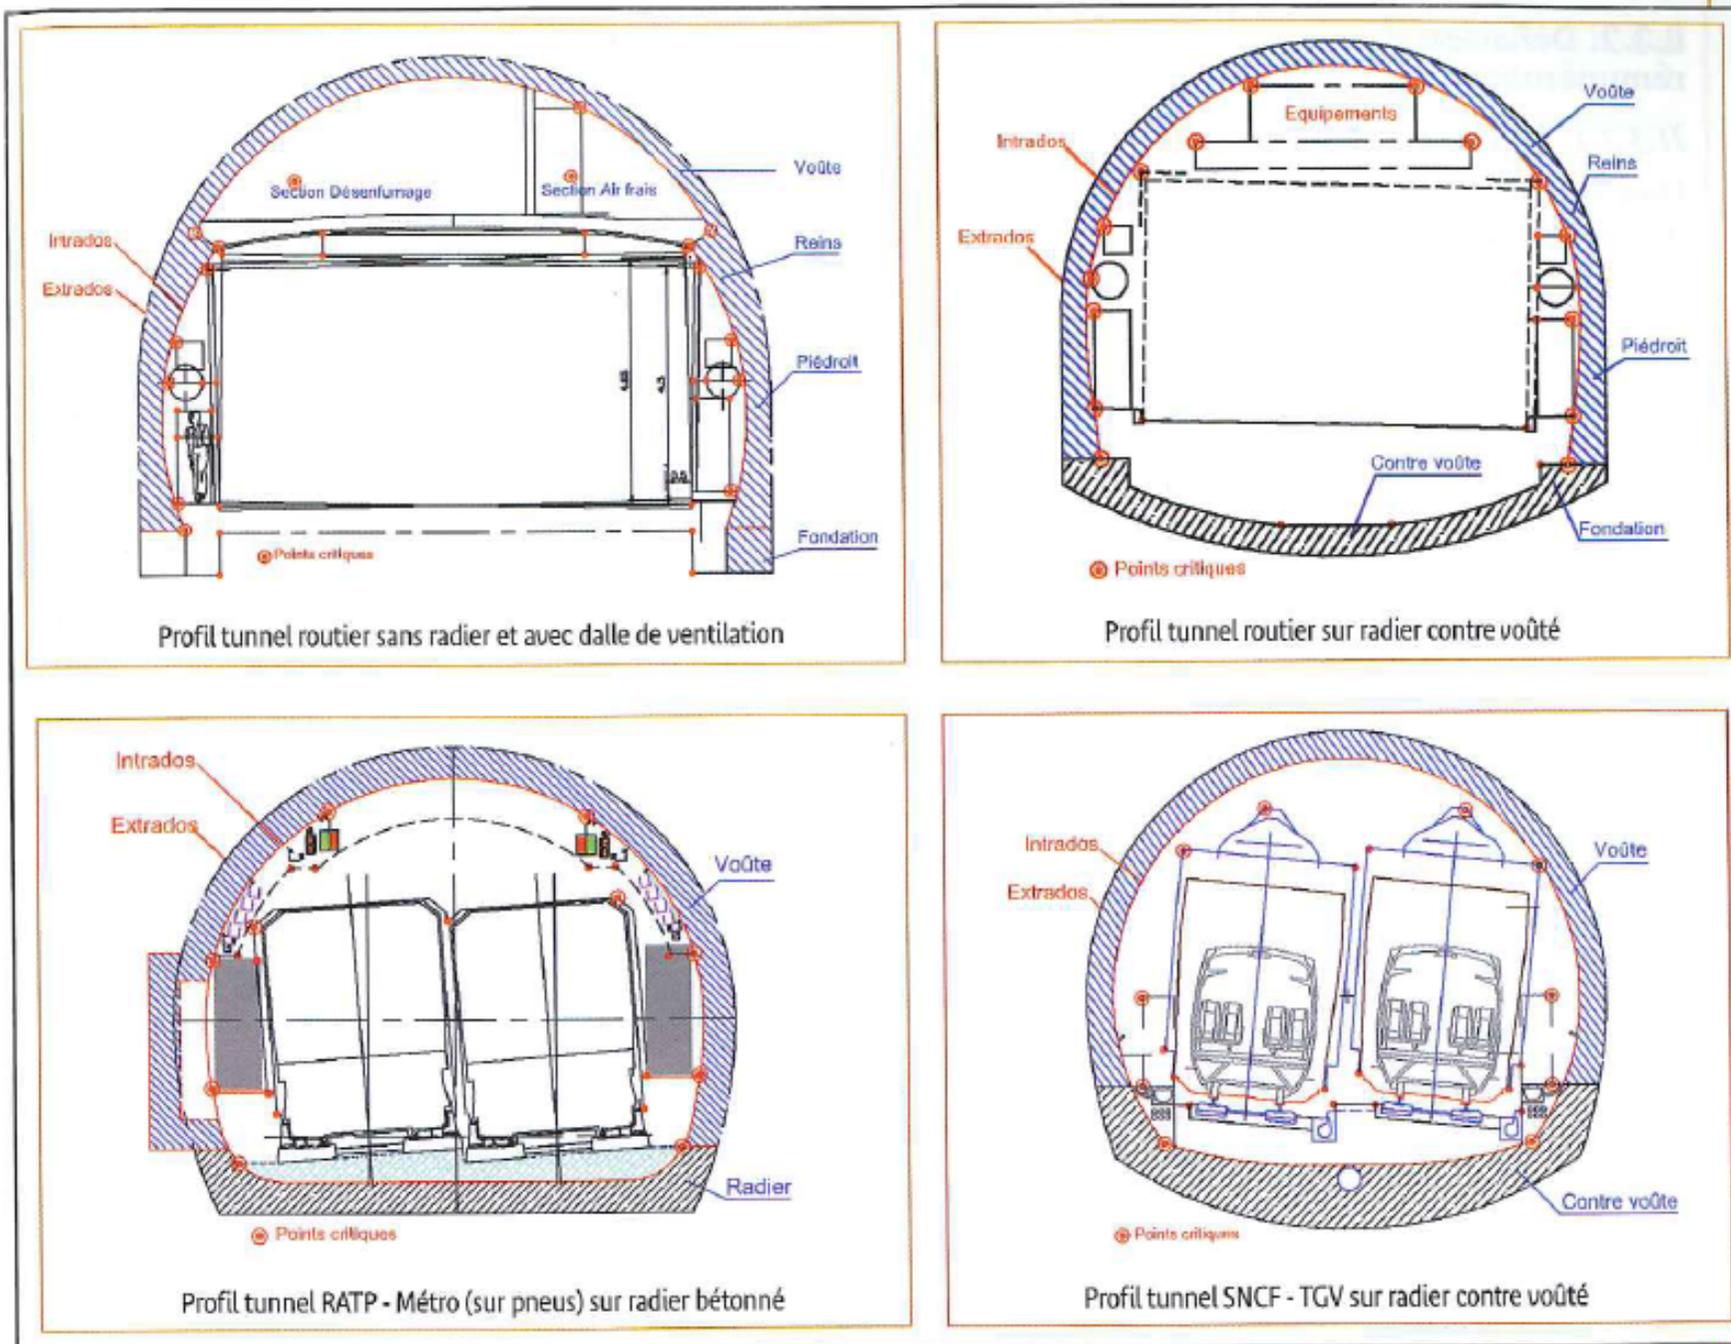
Exemples de formes de tunnel "Routier - Rail"
